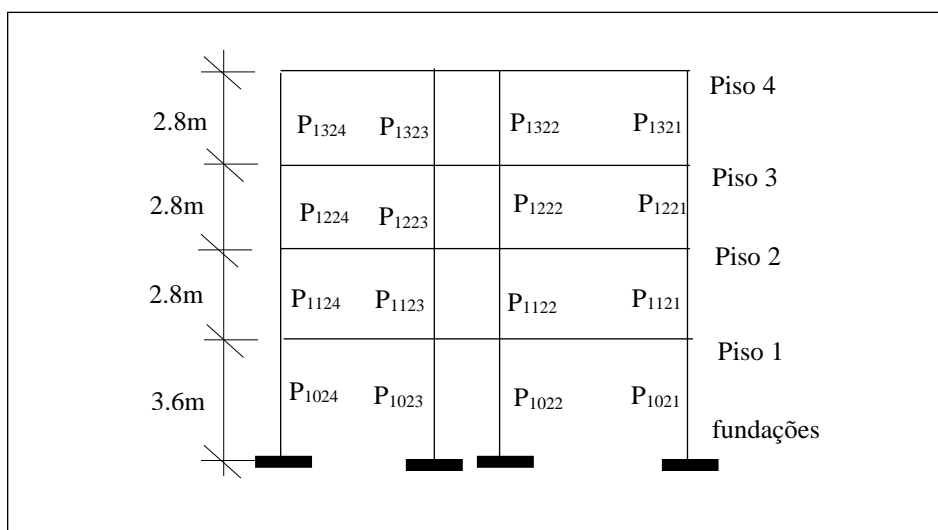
Numeração dos pilares de um pórtico da estrutura.
